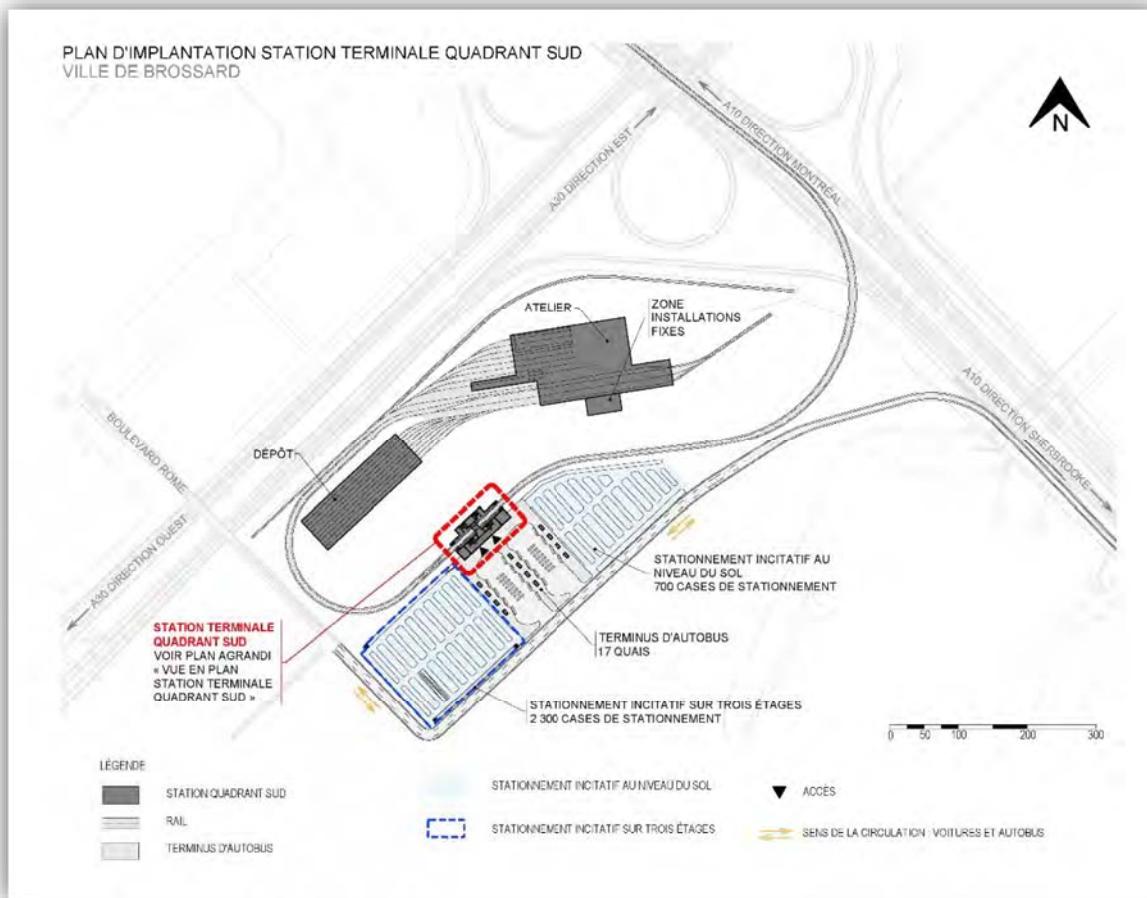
Implantation de la station terminale Rive-Sud et de ses équipements connexes
